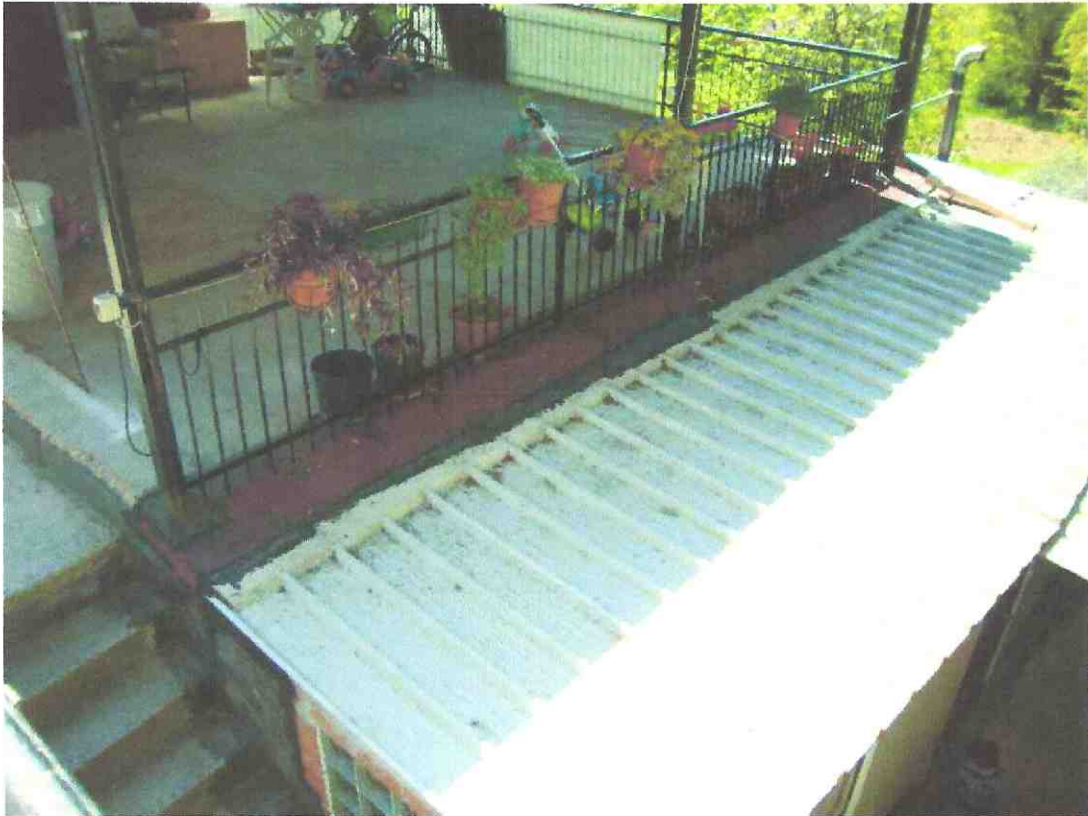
Particolare copertura ampliamento garage abusivamente realizzato
